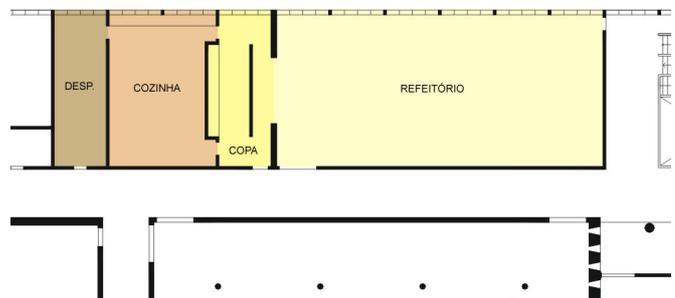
Conjunto de refeitório, copa, cozinha e despensa. Primeiro Pavimento. Obra construída. (Desenho da autora).
